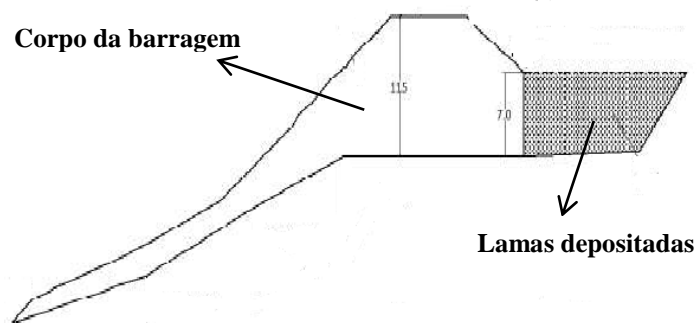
Esquema ilustrativo de corte longitudinal da barragem (adaptado de Duque, 2011)
